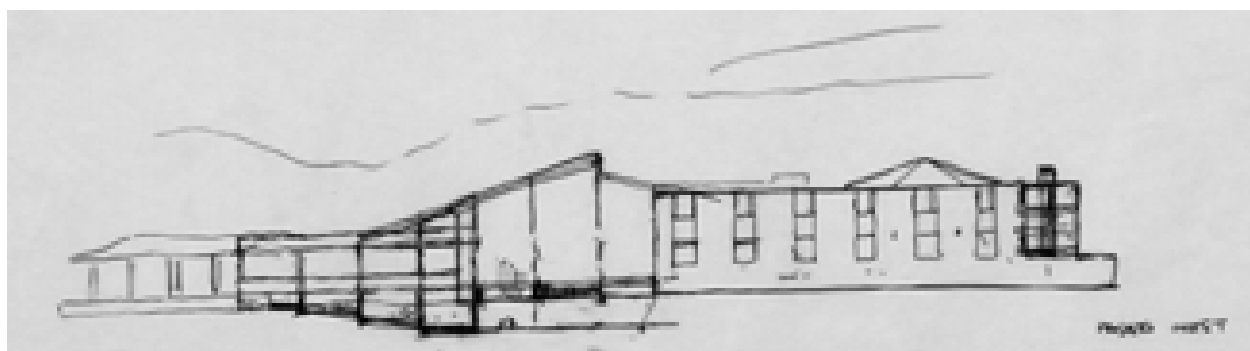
Prospetto ovest, stato futuro – 09/11/1993 (AABS-64_263)
